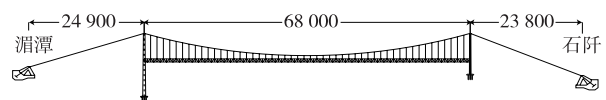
河闪渡乌江大桥立面布置示意图(单位: cm)
